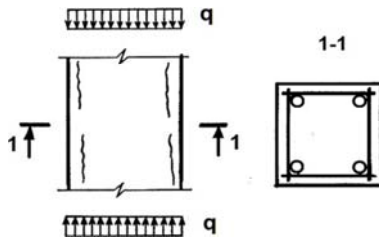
Трещины вдоль продольной арматуры в сжатых элементах
